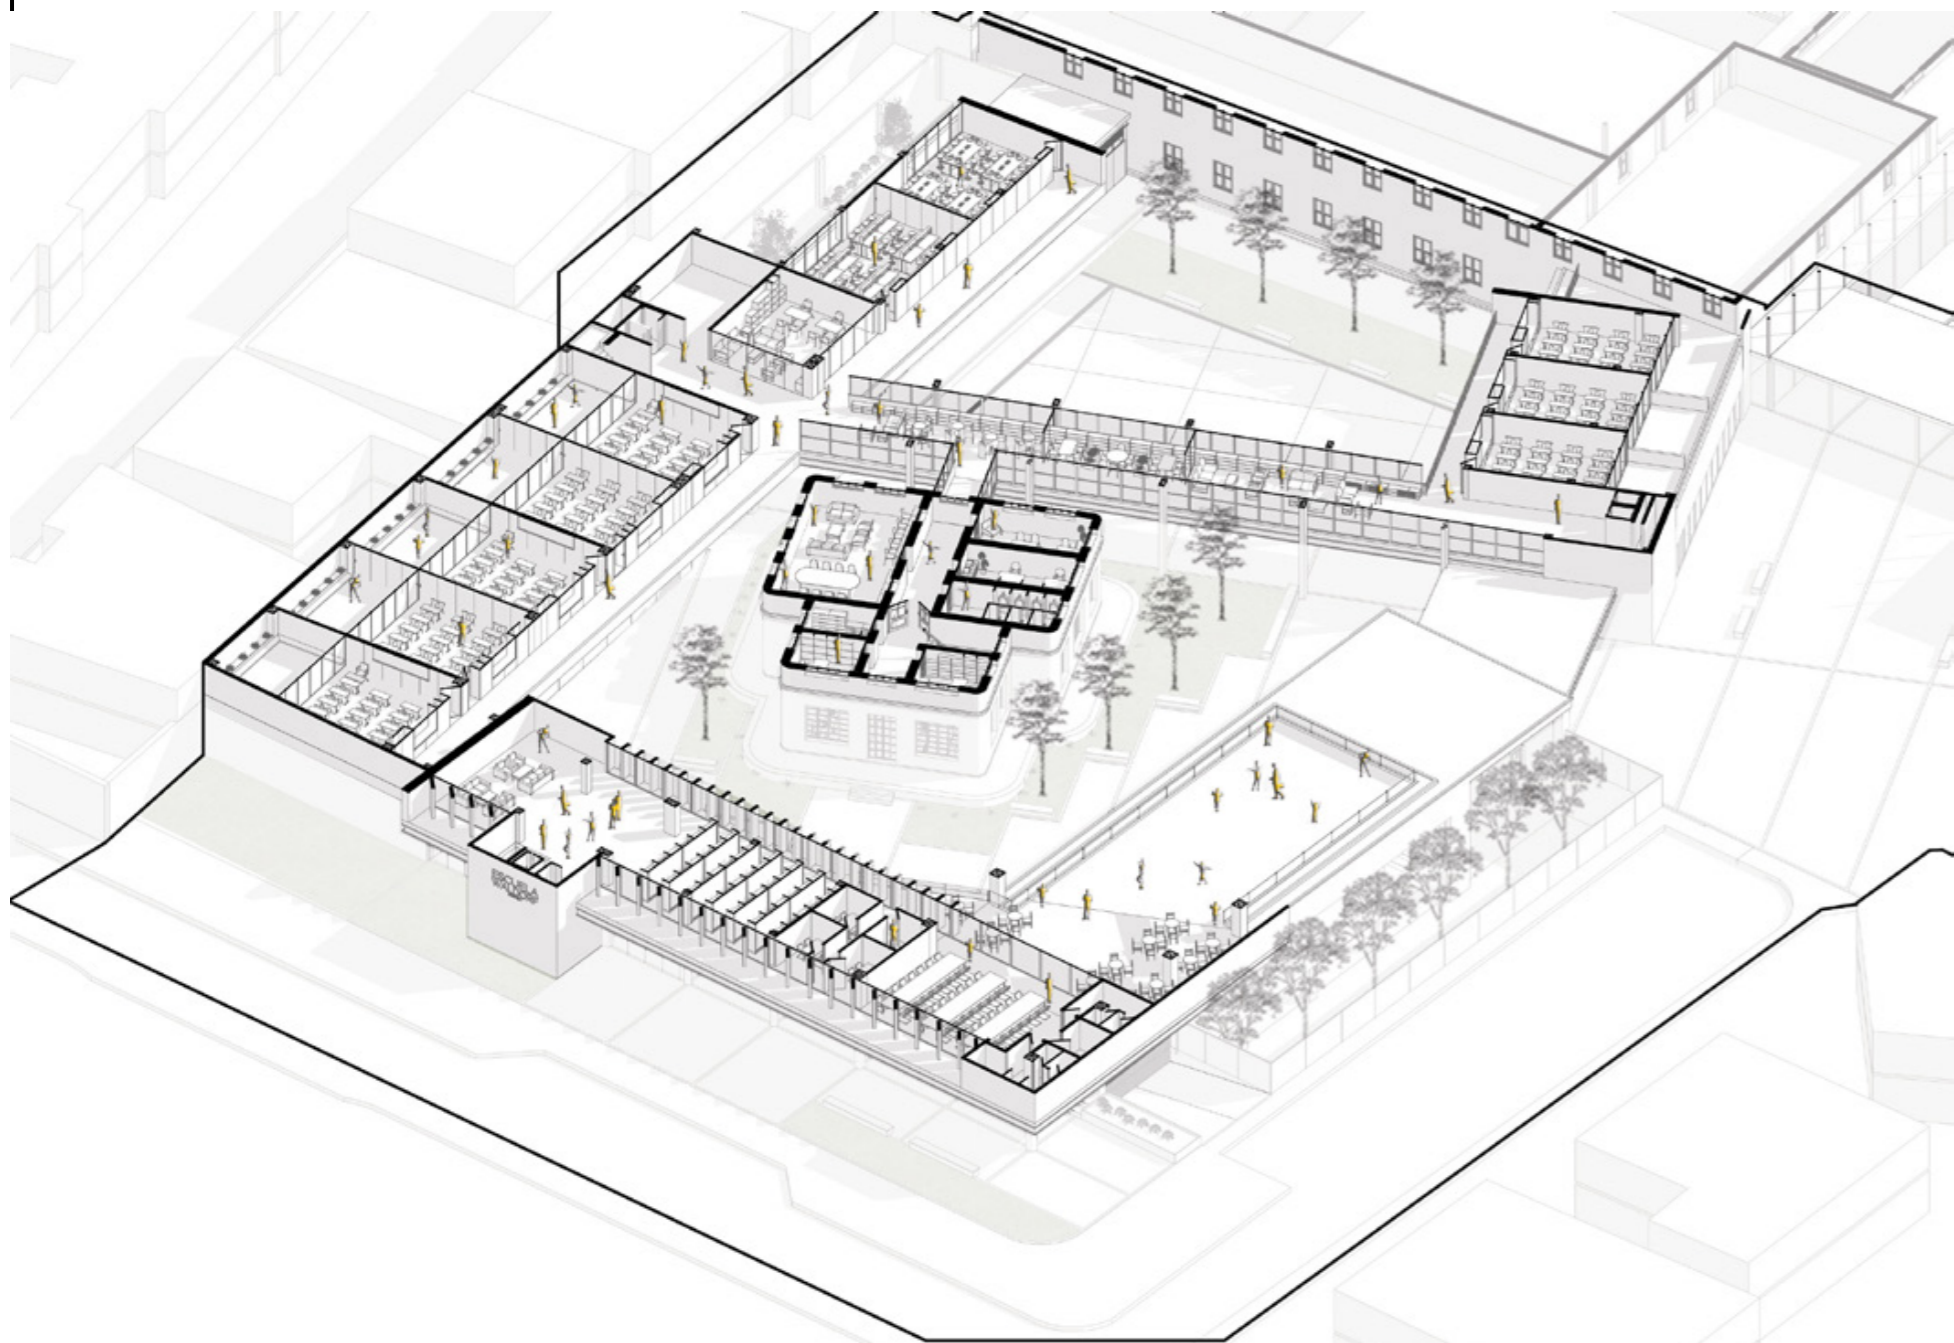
Axonometría Planta Alta | Fuente: Elaboración propia
